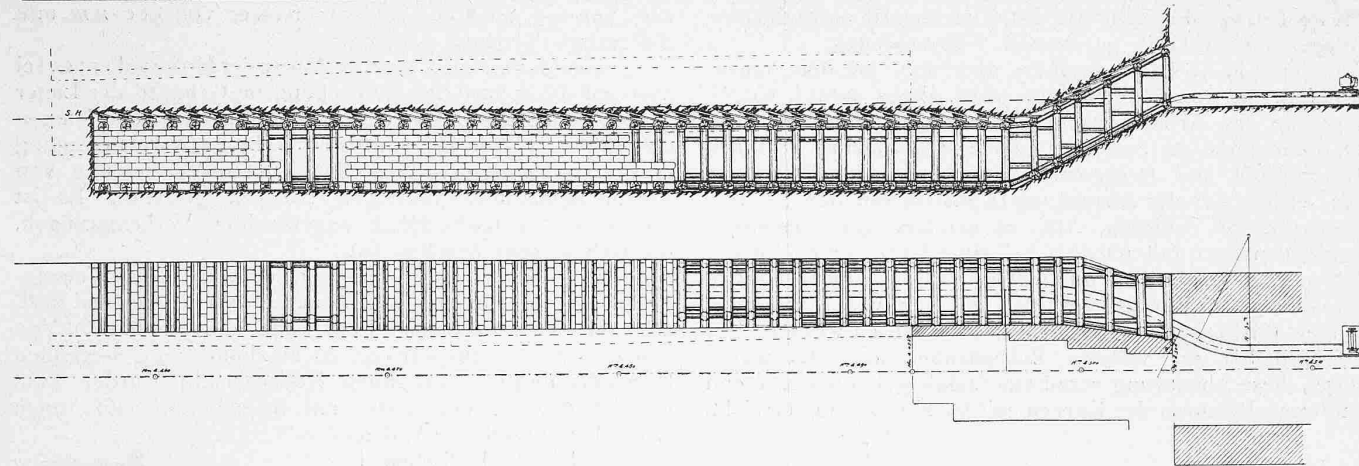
und 21. Grundriss und Längsschnitt durch Unterstollen links (westlich); Ausmauerung. — Masstab 1:300.
